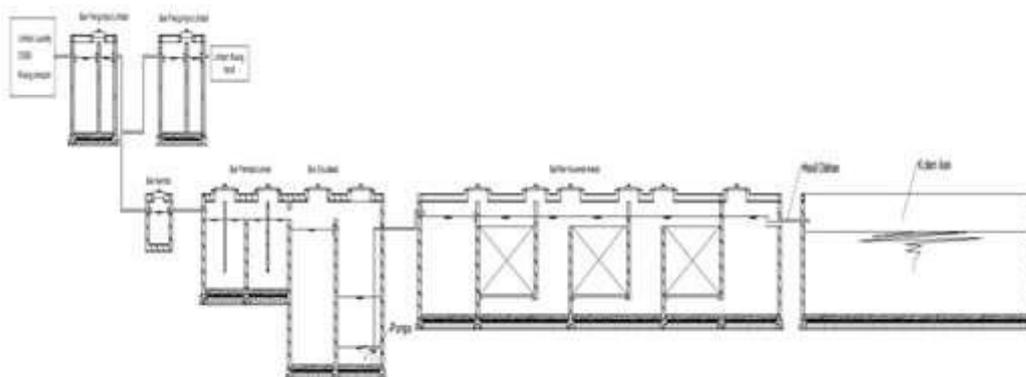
Penyelesaian Air Hujan pada Bangunan
